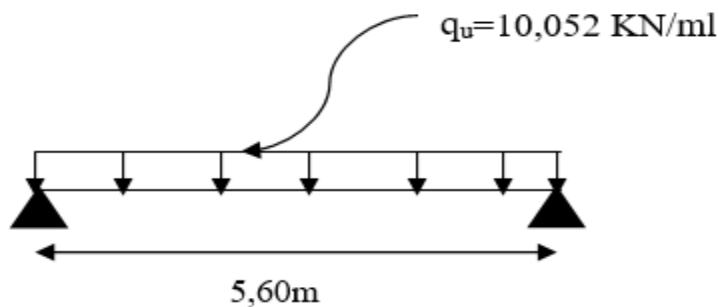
Coupe transversale de la poutrelle à une travée.
